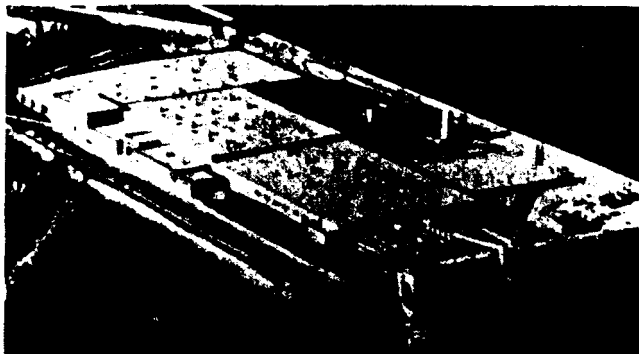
Moderno edificio industrial coa cubierta de asfalto.
